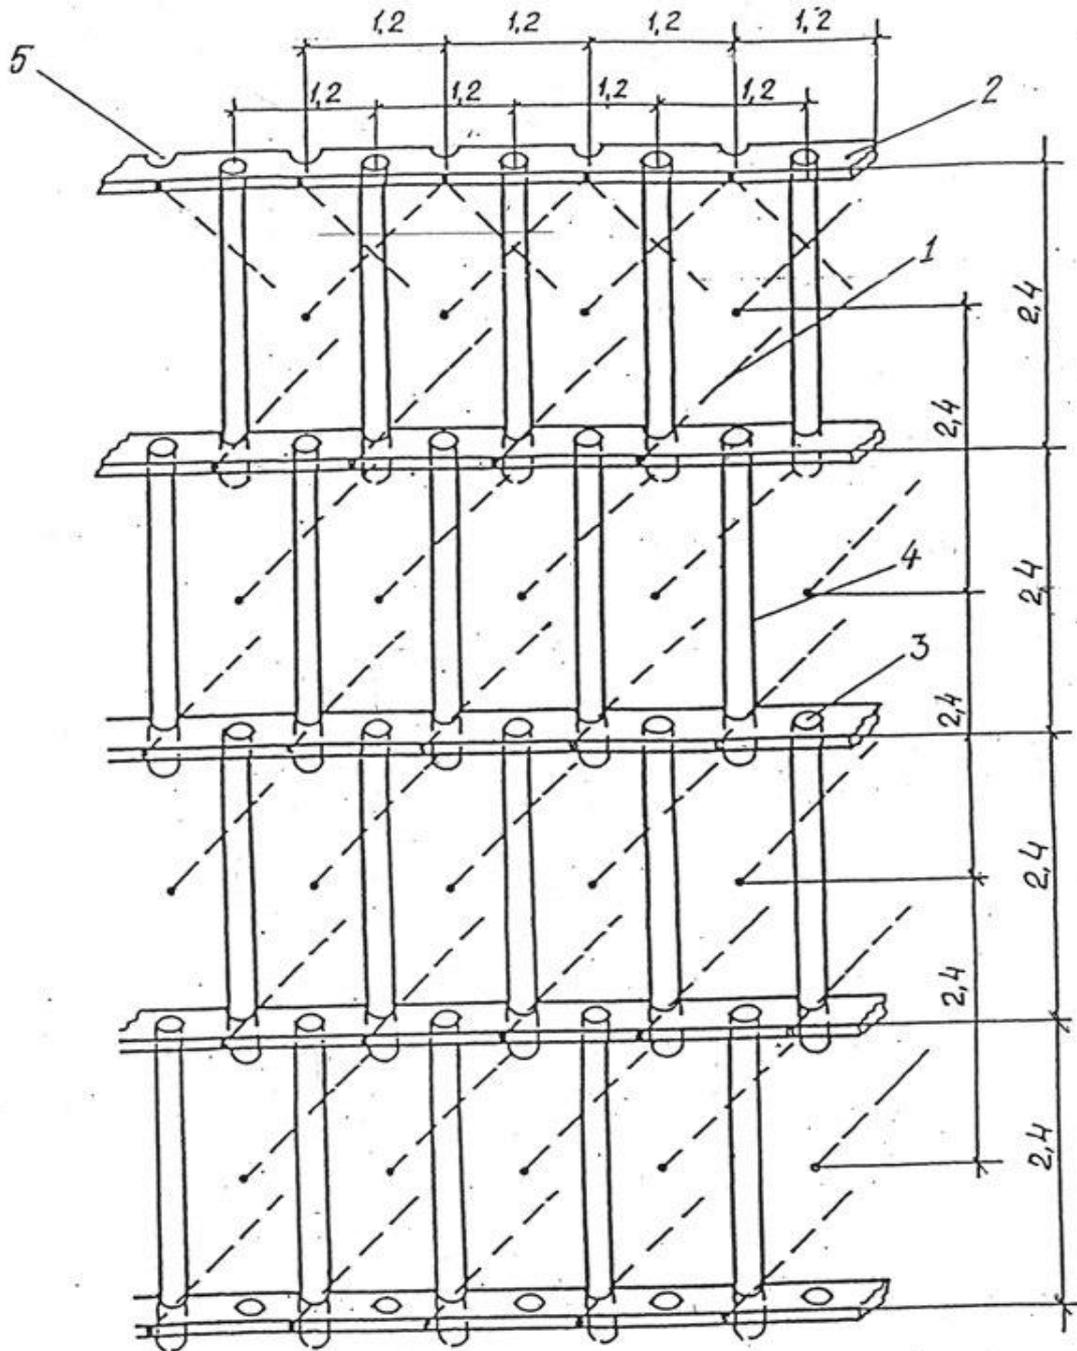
Типовая конструкция нагельного крепления со сборной защитной стенкой при применении АНК
